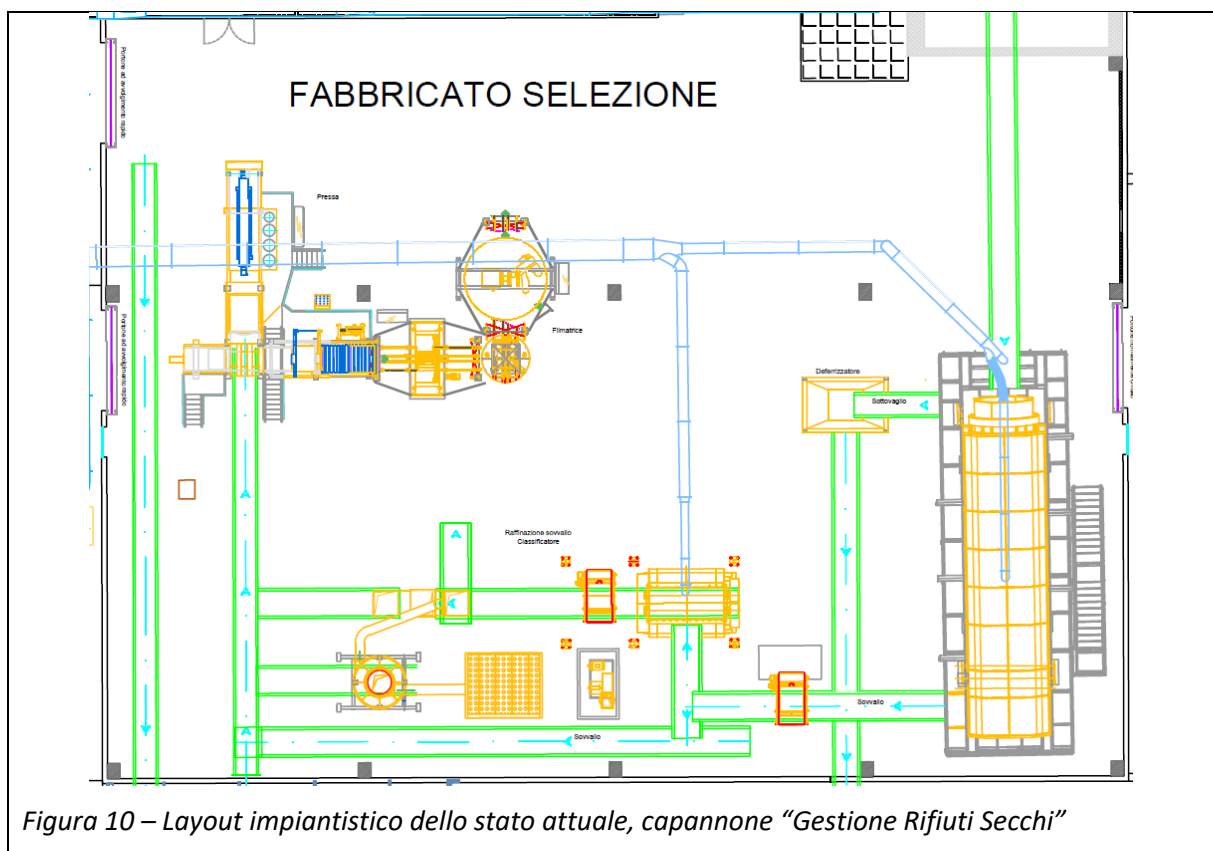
Layout impiantistico dello stato attuale, capannone "Gestione Rifiuti Secchi"
